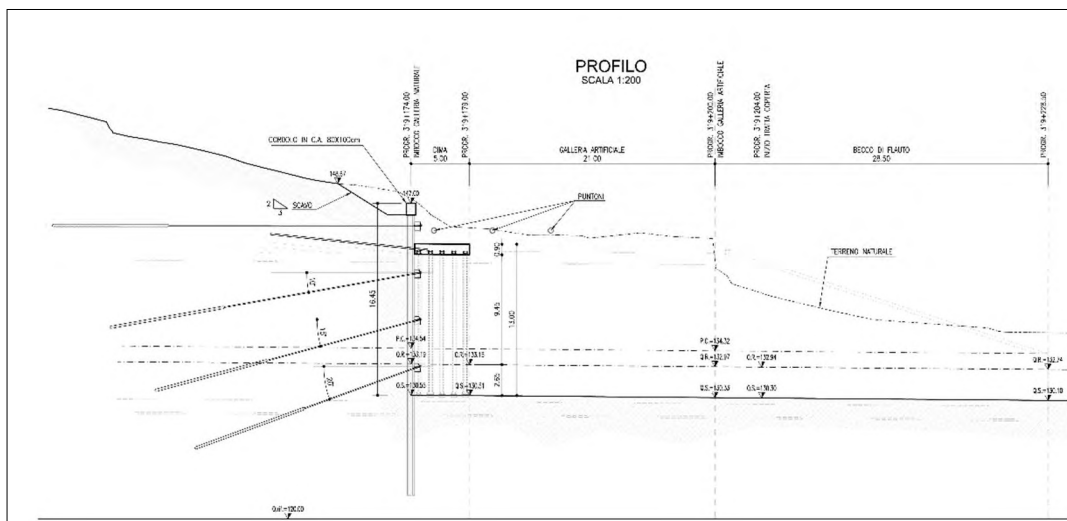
Profilo longitudinale imbocco Sud Bruschetto (IB02S, Stralcio da elab. APE2151)
